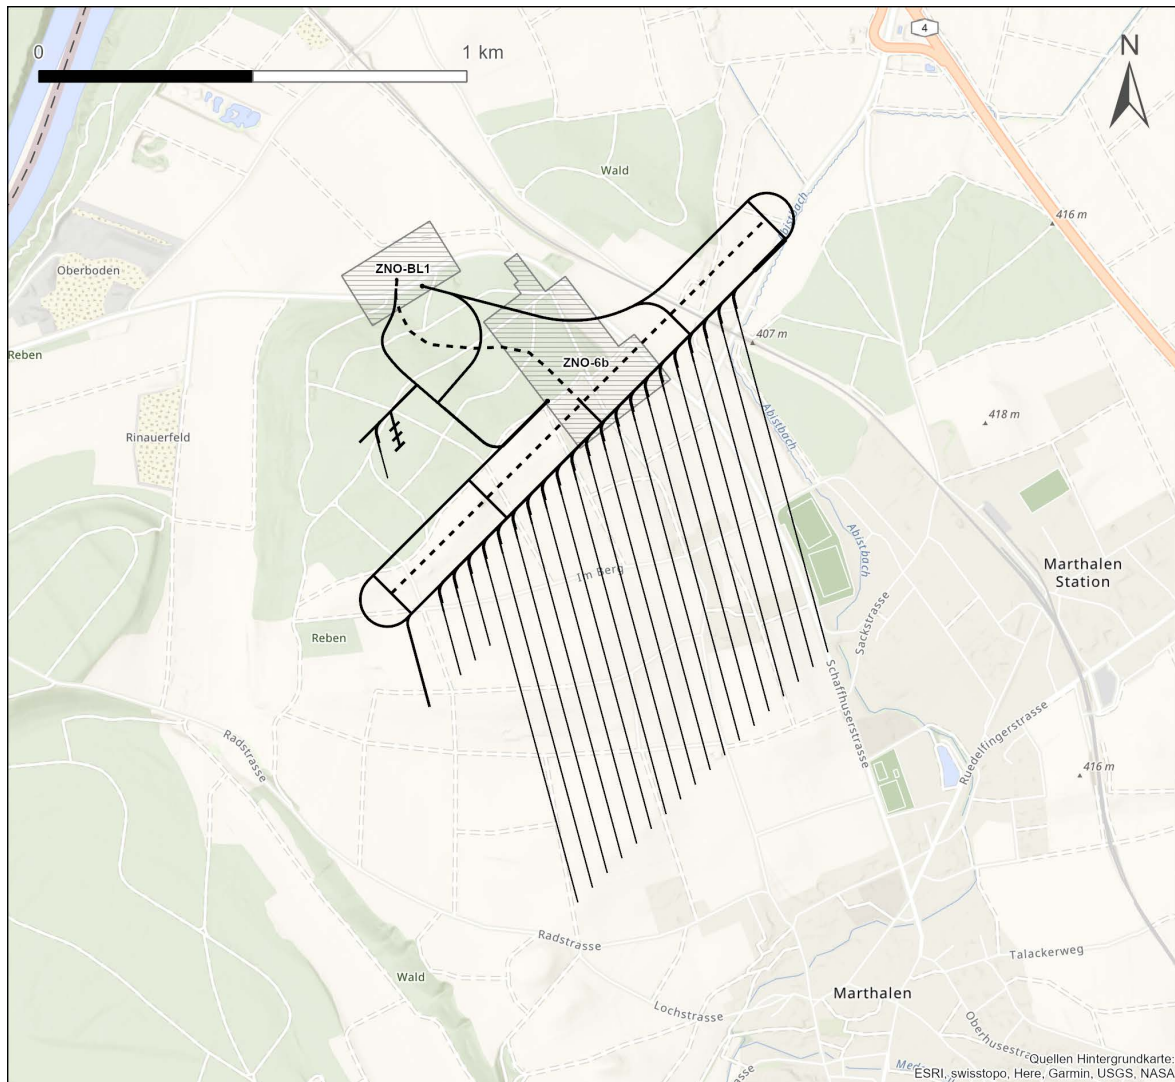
Situationsplan und Grundriss mit der für die KS21 angenommenen modellhaften Anordnung der Anlagen und Bauten für ein HAA-Lager im Standortgebiet Zürich Nordost (ZNO).
